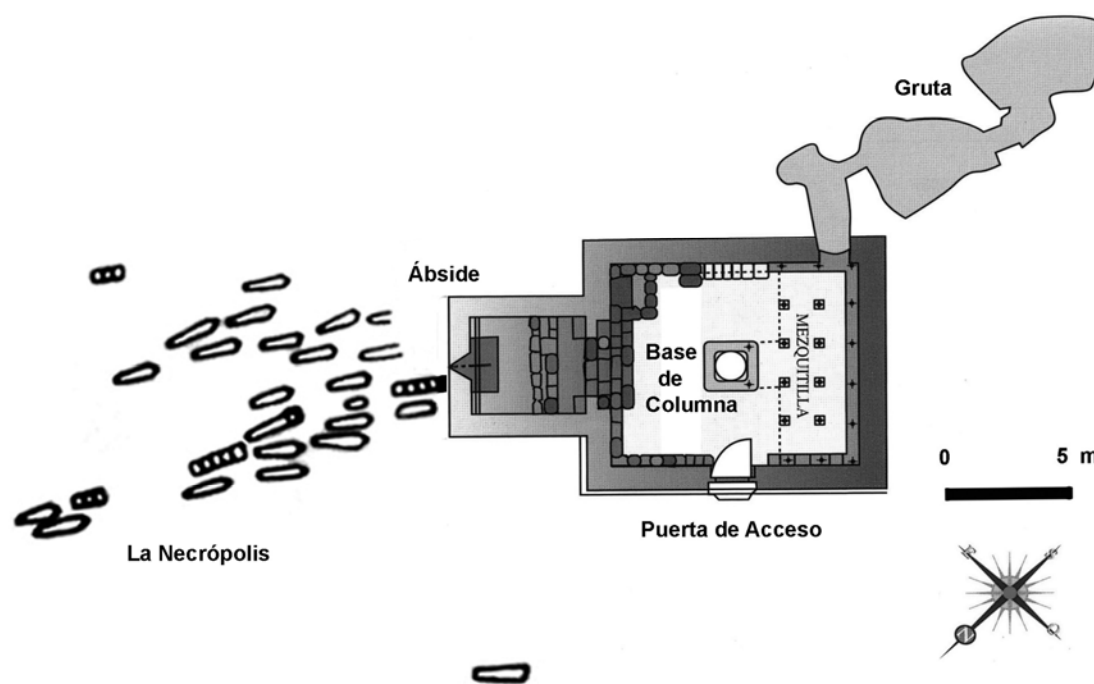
Plano de la Ermita con el cementerio (Modificado de: Escolano, 2003).
